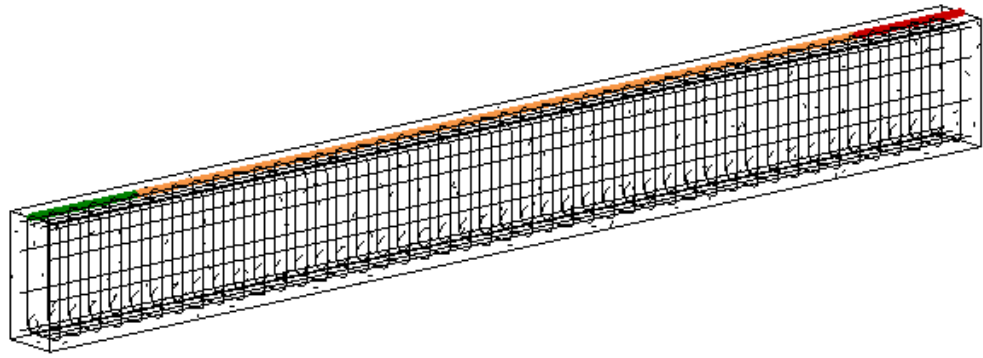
Viga 0.75 x 0.35 m modelado 3d en Revit
